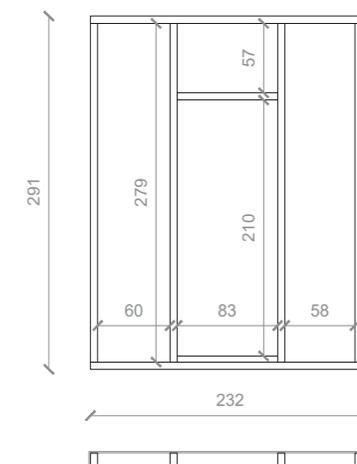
Prospetto quotato chiusura verticale prefabbricata 07
